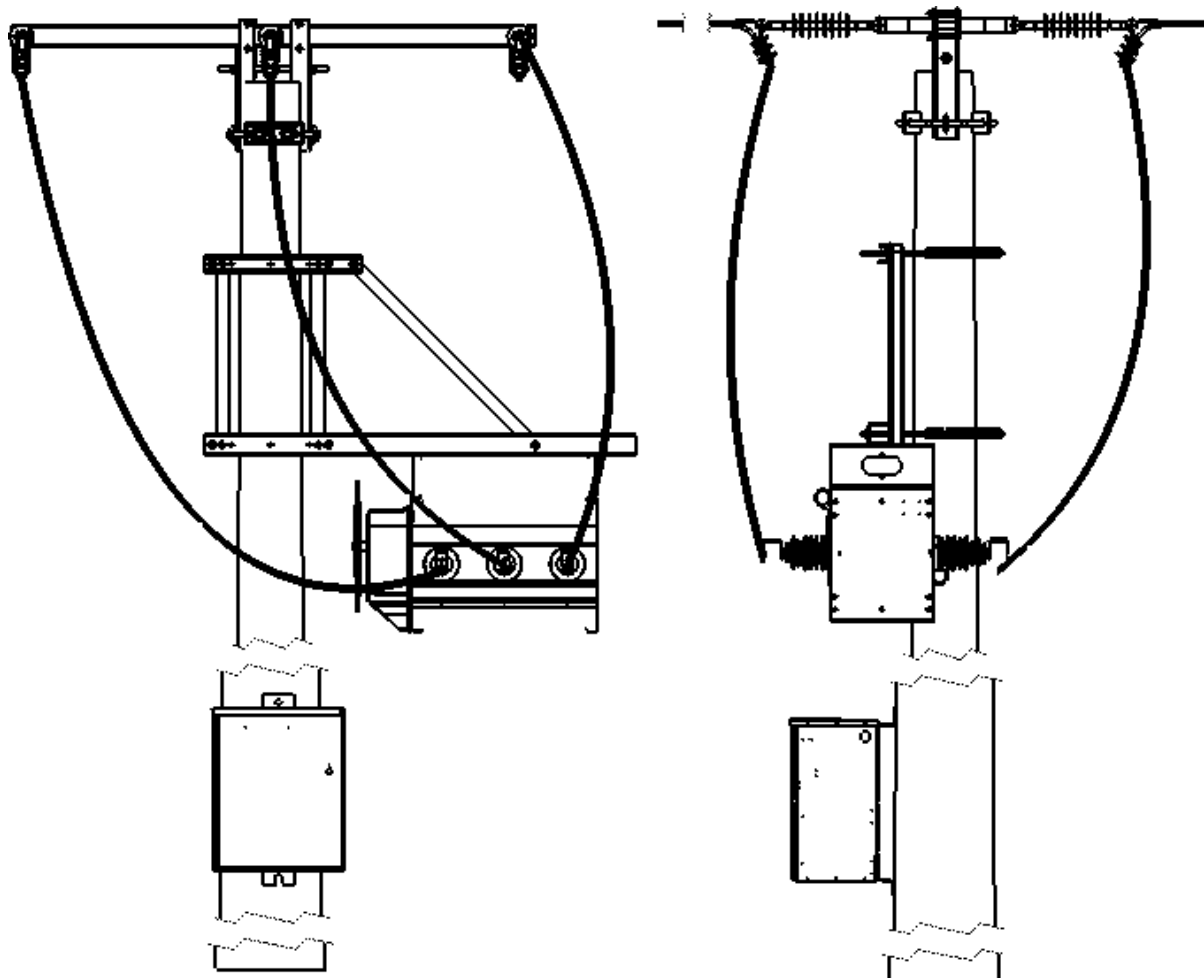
Montaż NXA na 1 słupie okrągłym betonowym, poniżej poprzeczki, działanie silnikowe
